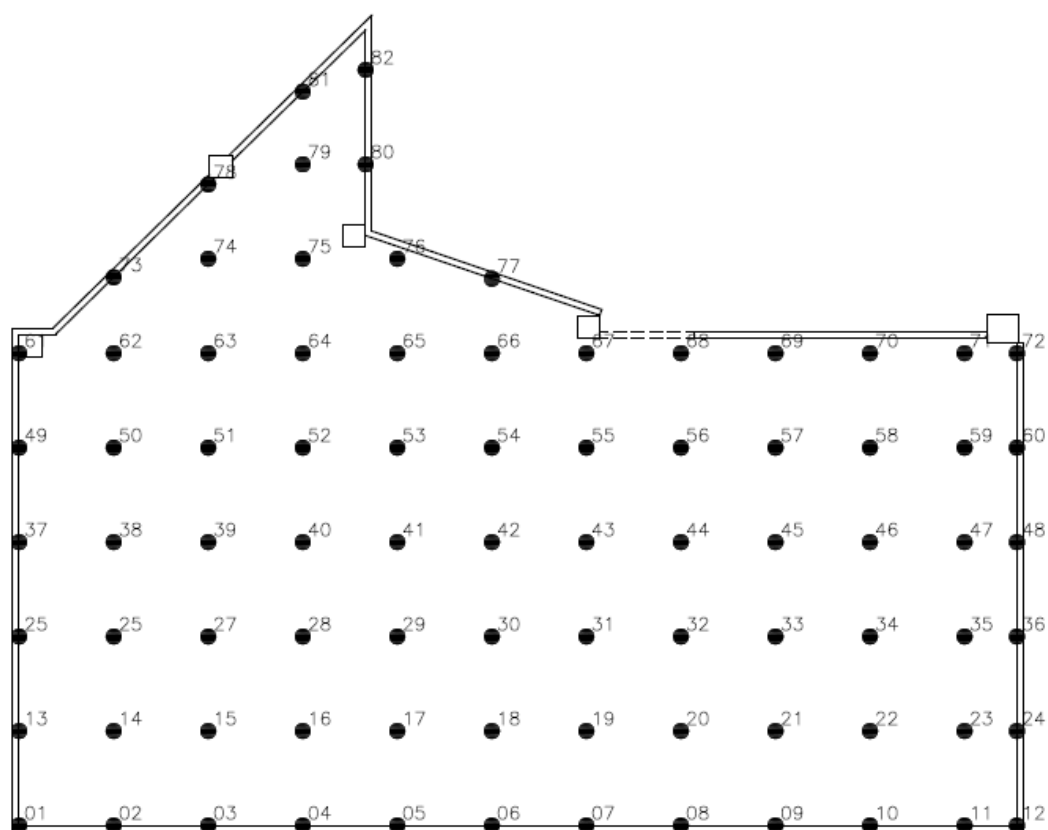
Planta baixa da sala de leitura. Fonte: elaborado pelos autores.
